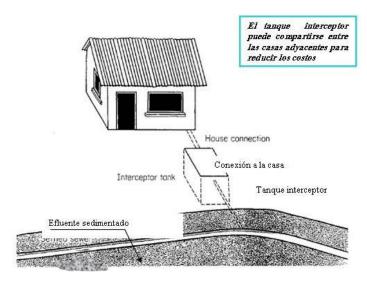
Alcantarillado de pequeño diámetro. Tomada de la guía para el diseño de alcantarillado.
